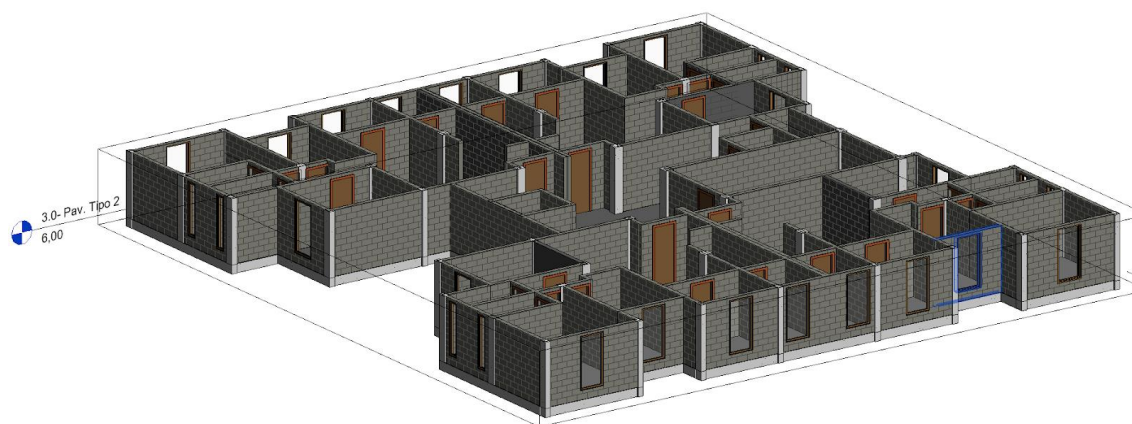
Apresentação do pavimento tipo da edificação modelado no ambiente Revit
